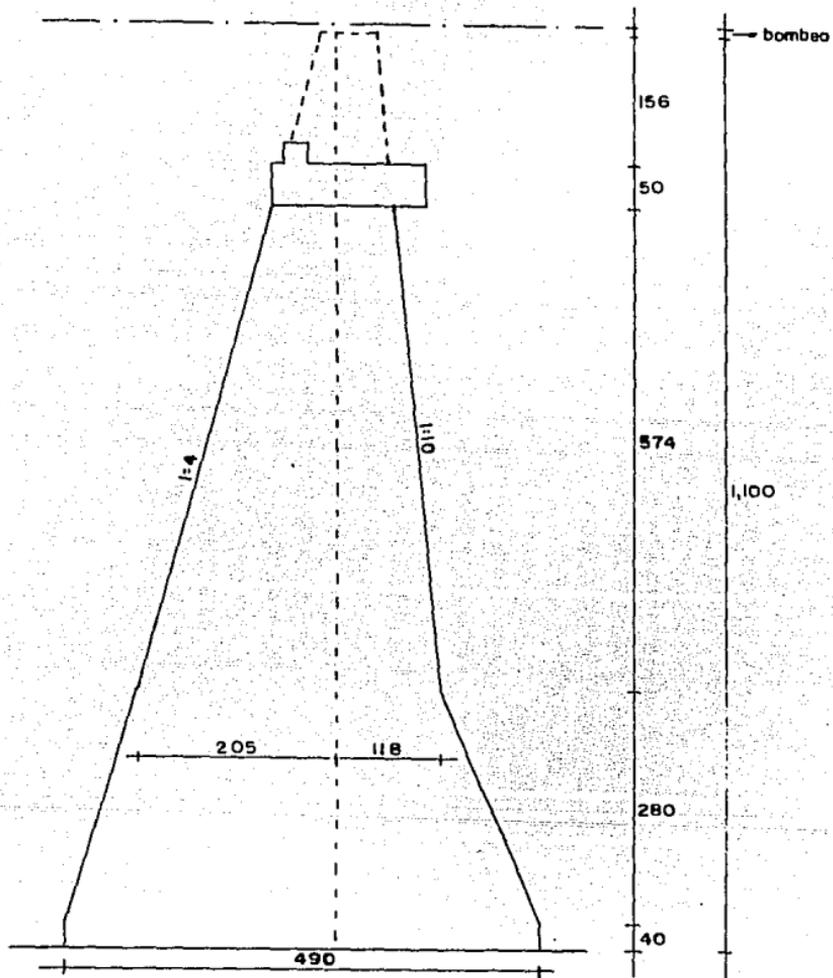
Sección transversal de los estribos de concreto en el puente.
